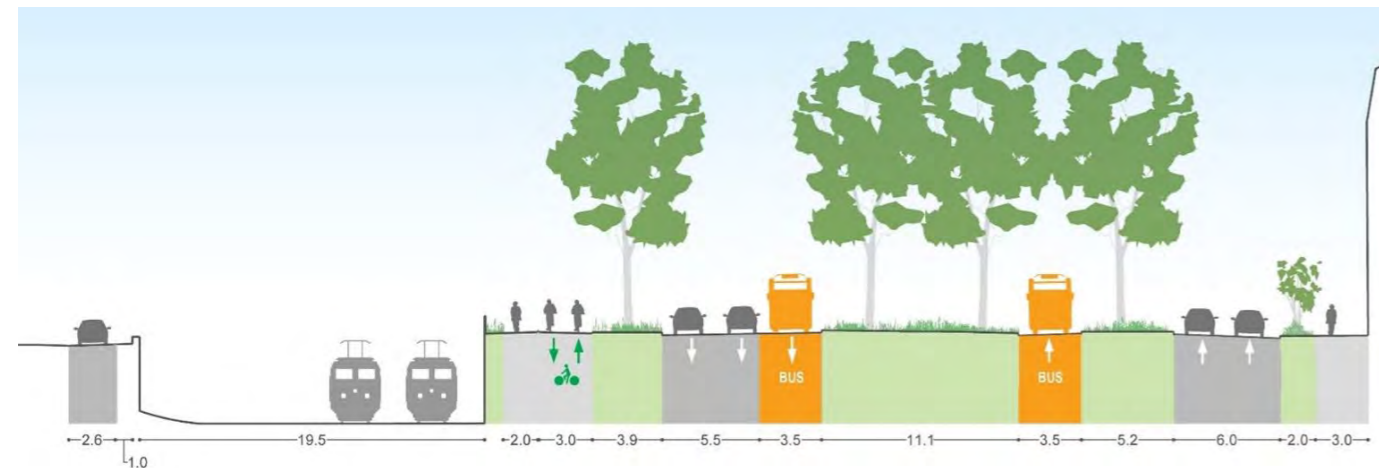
Profil projeté du boulevard Saint-Euverte (Source : groupement AMO – étude Plan Guide 2023)
